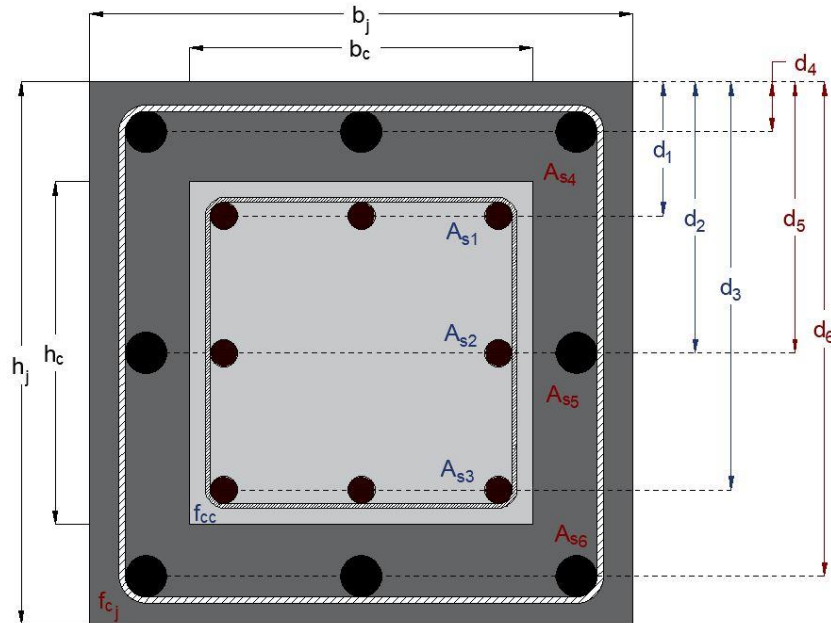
Identificación de las filas de refuerzo longitudinal en la sección transversal de la columna encamisada, para el cálculo de la resistencia a flexión
